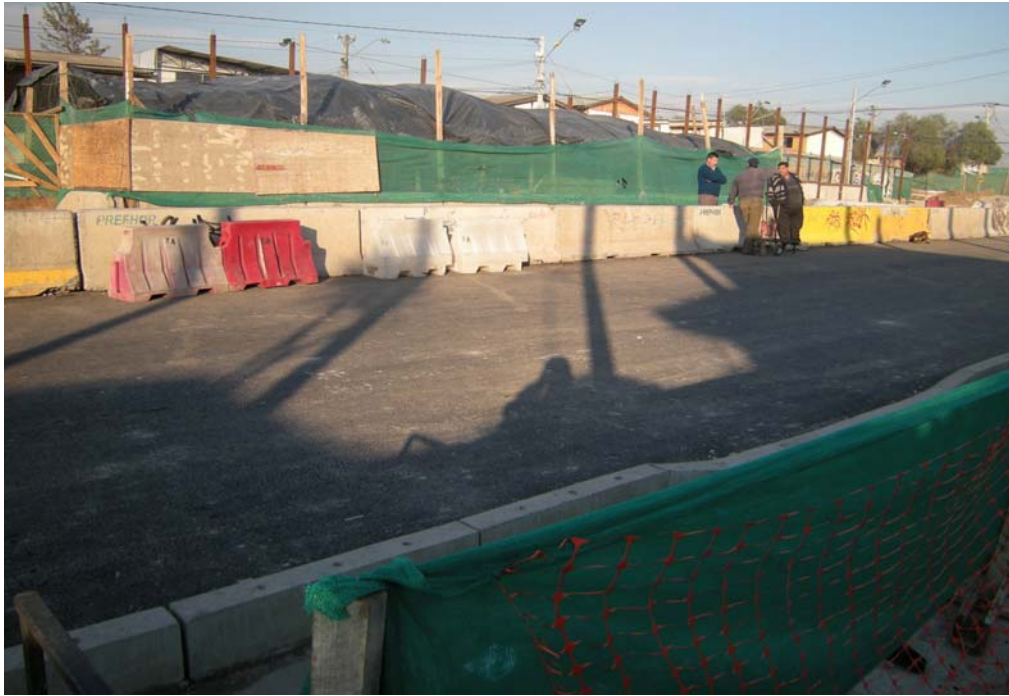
Zona Control 1. Calzada poniente con asfalto. Sin novedad.
